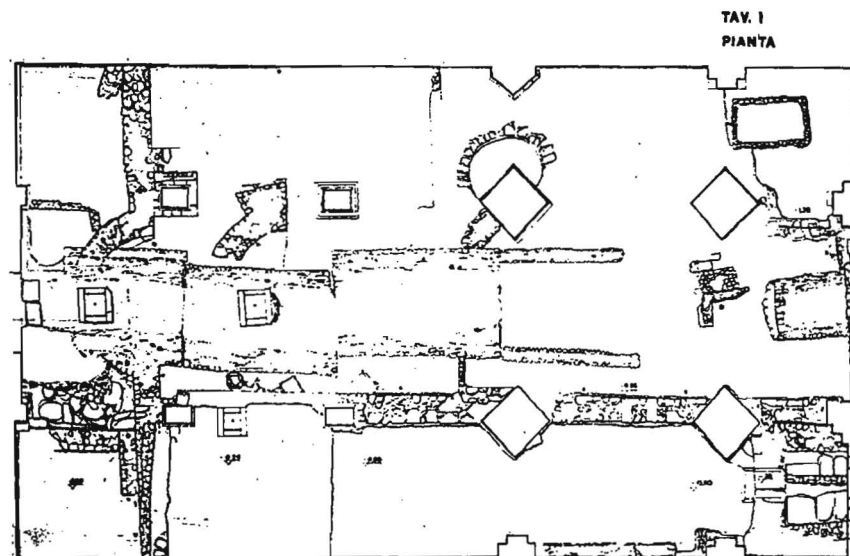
S. Maria Maggiore: planimetria delle strutture emerse dallo scavo (da Ungaro-Motta, 1986)
